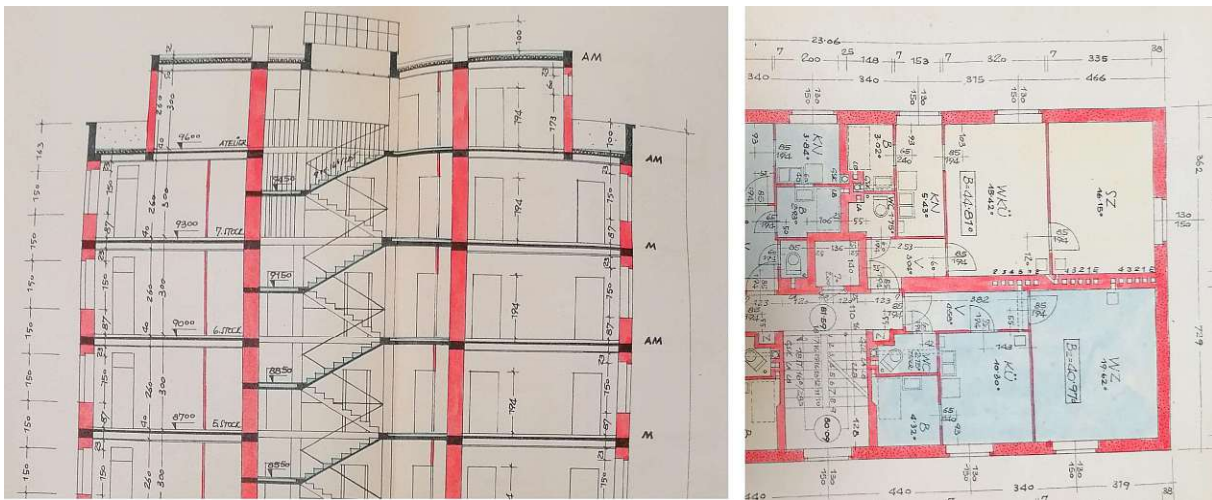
Planausschnitt Unter-Meidlinger Straße 12–16: Ausschnitt Schnitt Hochhaus (links), Grundriss 5. Stock mit Vibromauerwerk Stiege 21 (rechts) [52]
